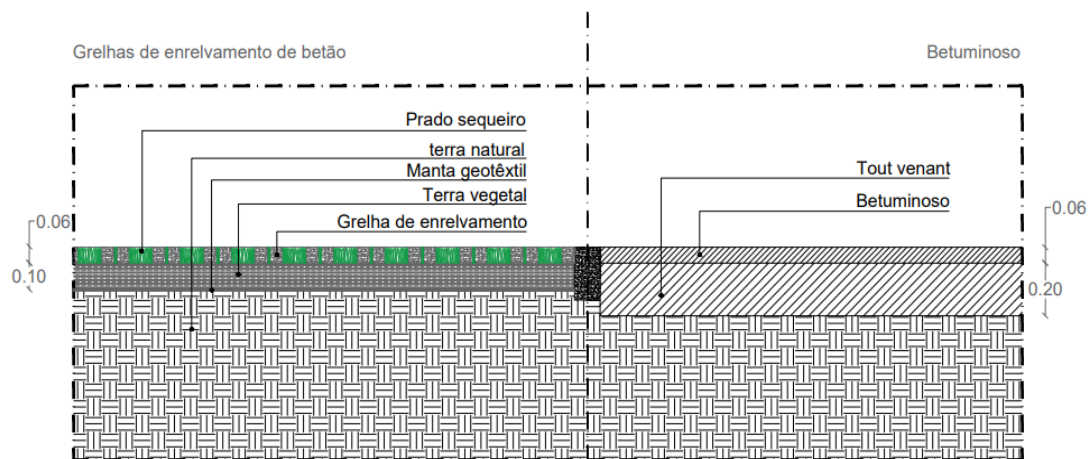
Corte de um pavimento em grelha de enrelvamento em betão em oposição a um betuminoso. Fonte: (Acioli, 2005).
